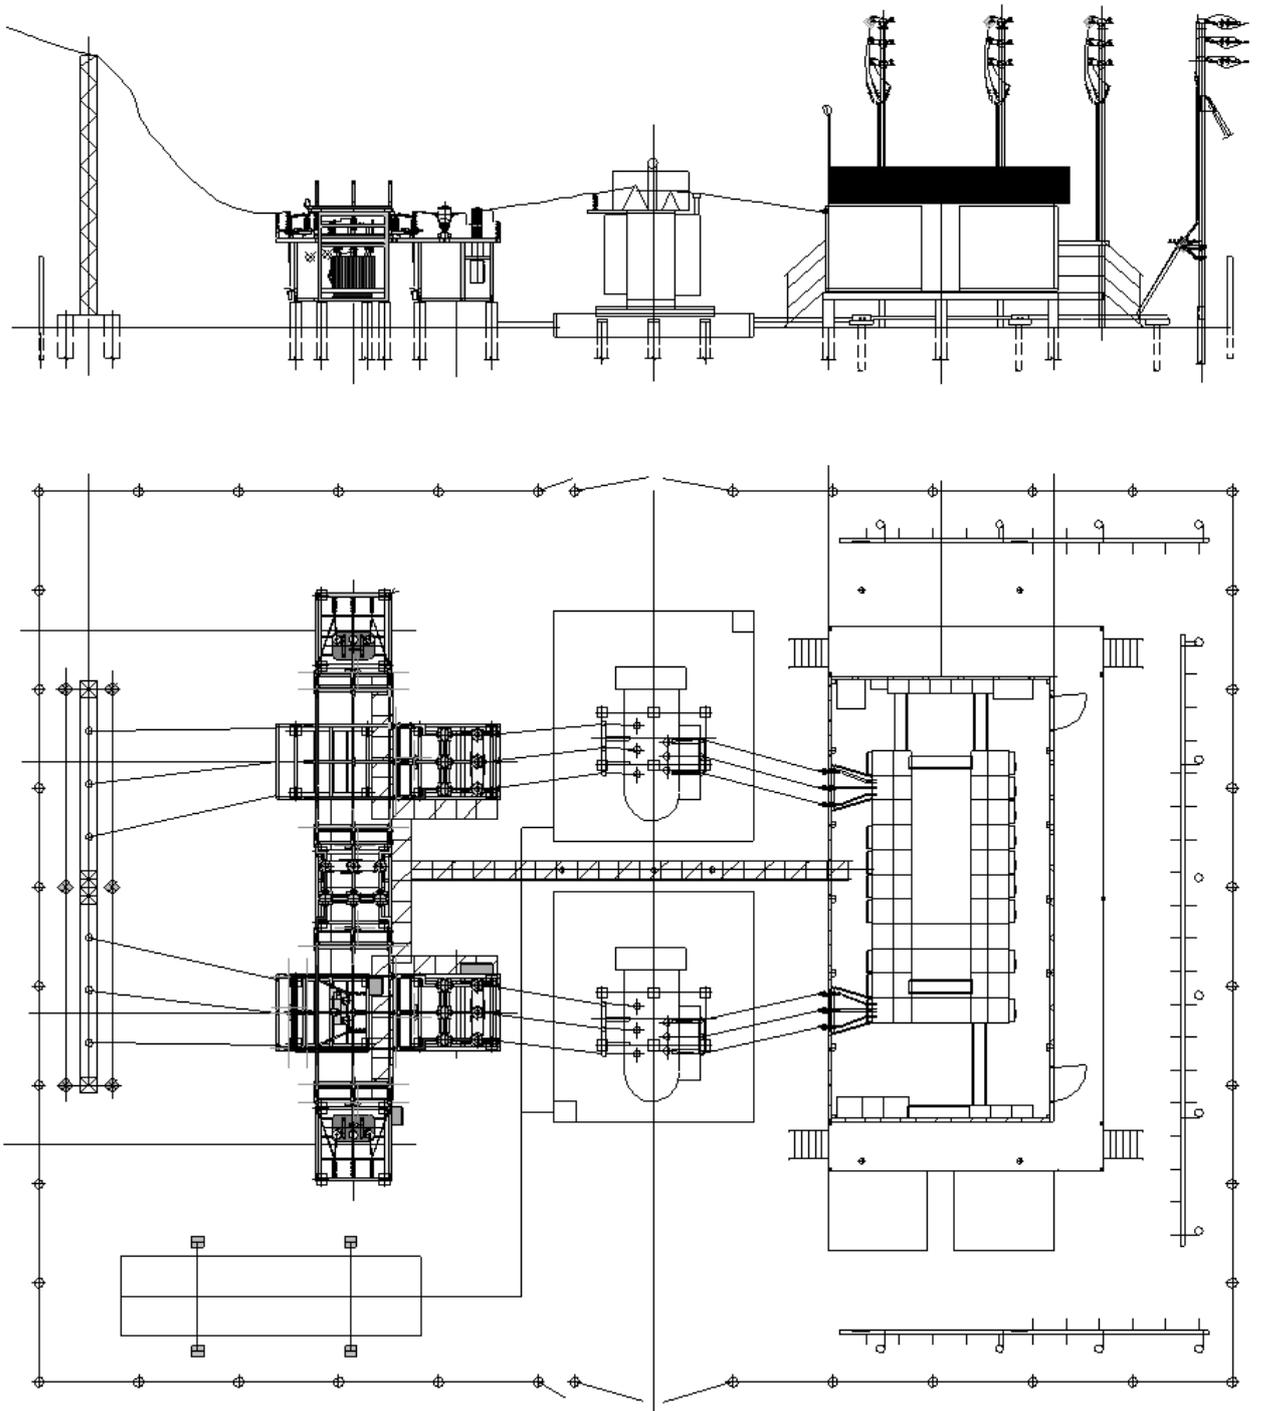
План подстанции 35 кВ по схеме 35-5АНА.
